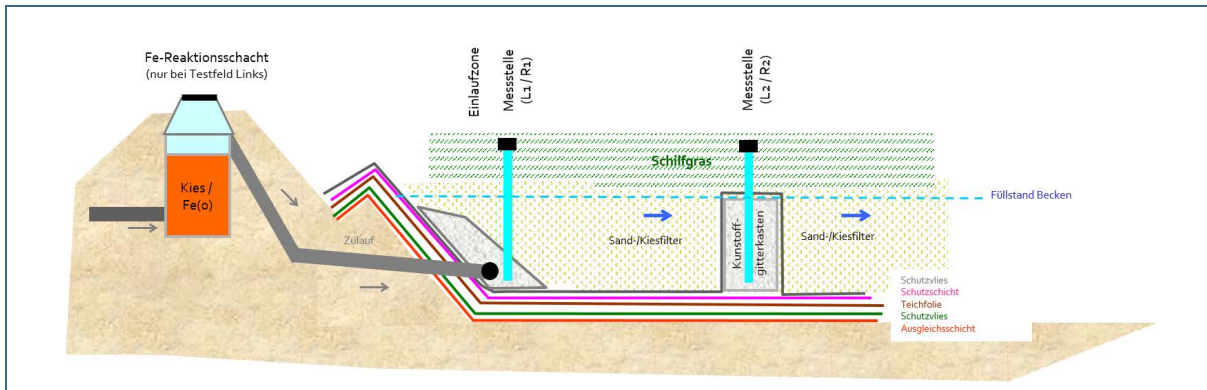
Funktioneller Aufbau einer Wasserreinigungsanlage "Constructed Wetland".
